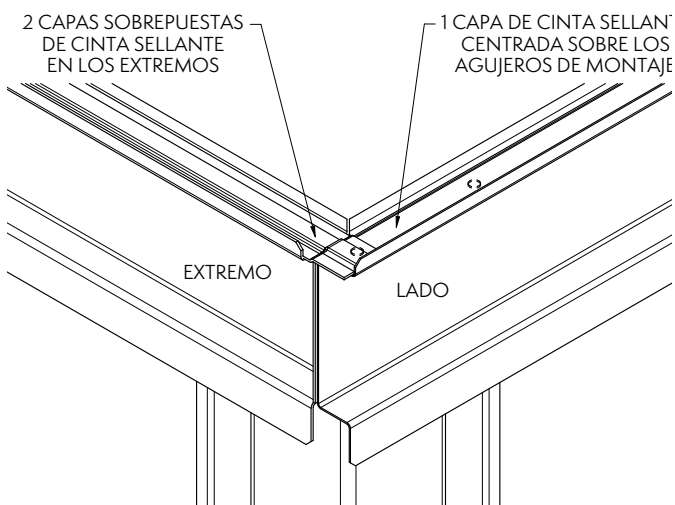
Cinta sellante en la pestaña de la sección inferior
